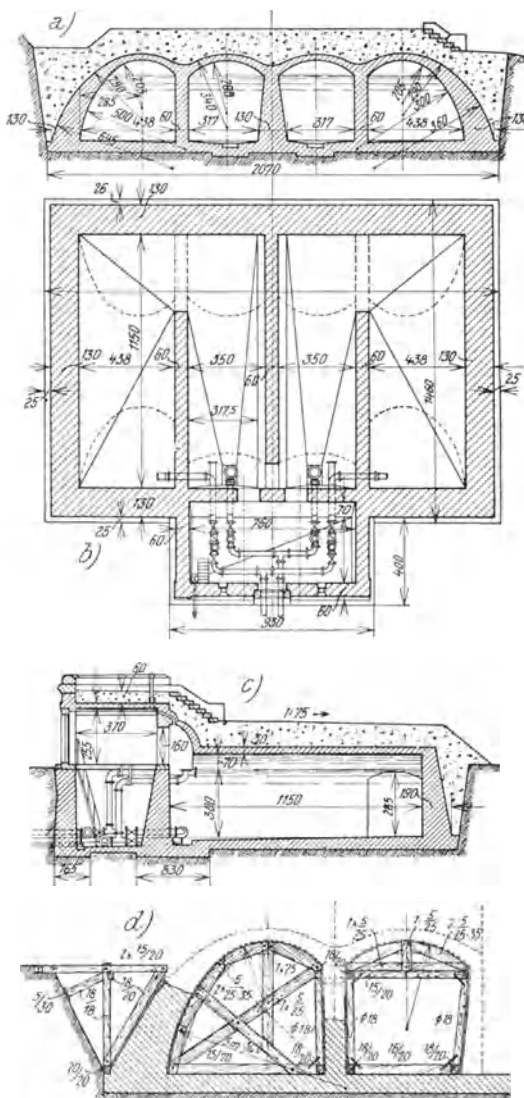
Rechteckiger Wasserkeller mit zwei Kammern, eingedeckt mit Gewölben mit verloreinem Widerlager. a) Querschnitt, b) Grundriß, c) Längsschnitt, d) Schalung. (Nach V. Hrasky)
